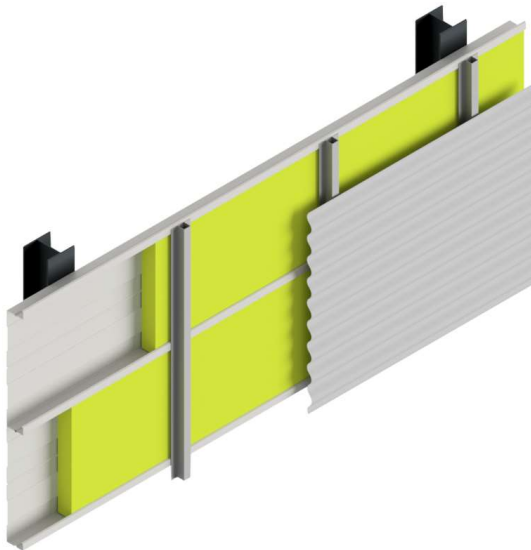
Ausschnitt einer Kassettenprofilfassade der ersten Generation mit horizontal verlegter Wellprofil-Außenschale
